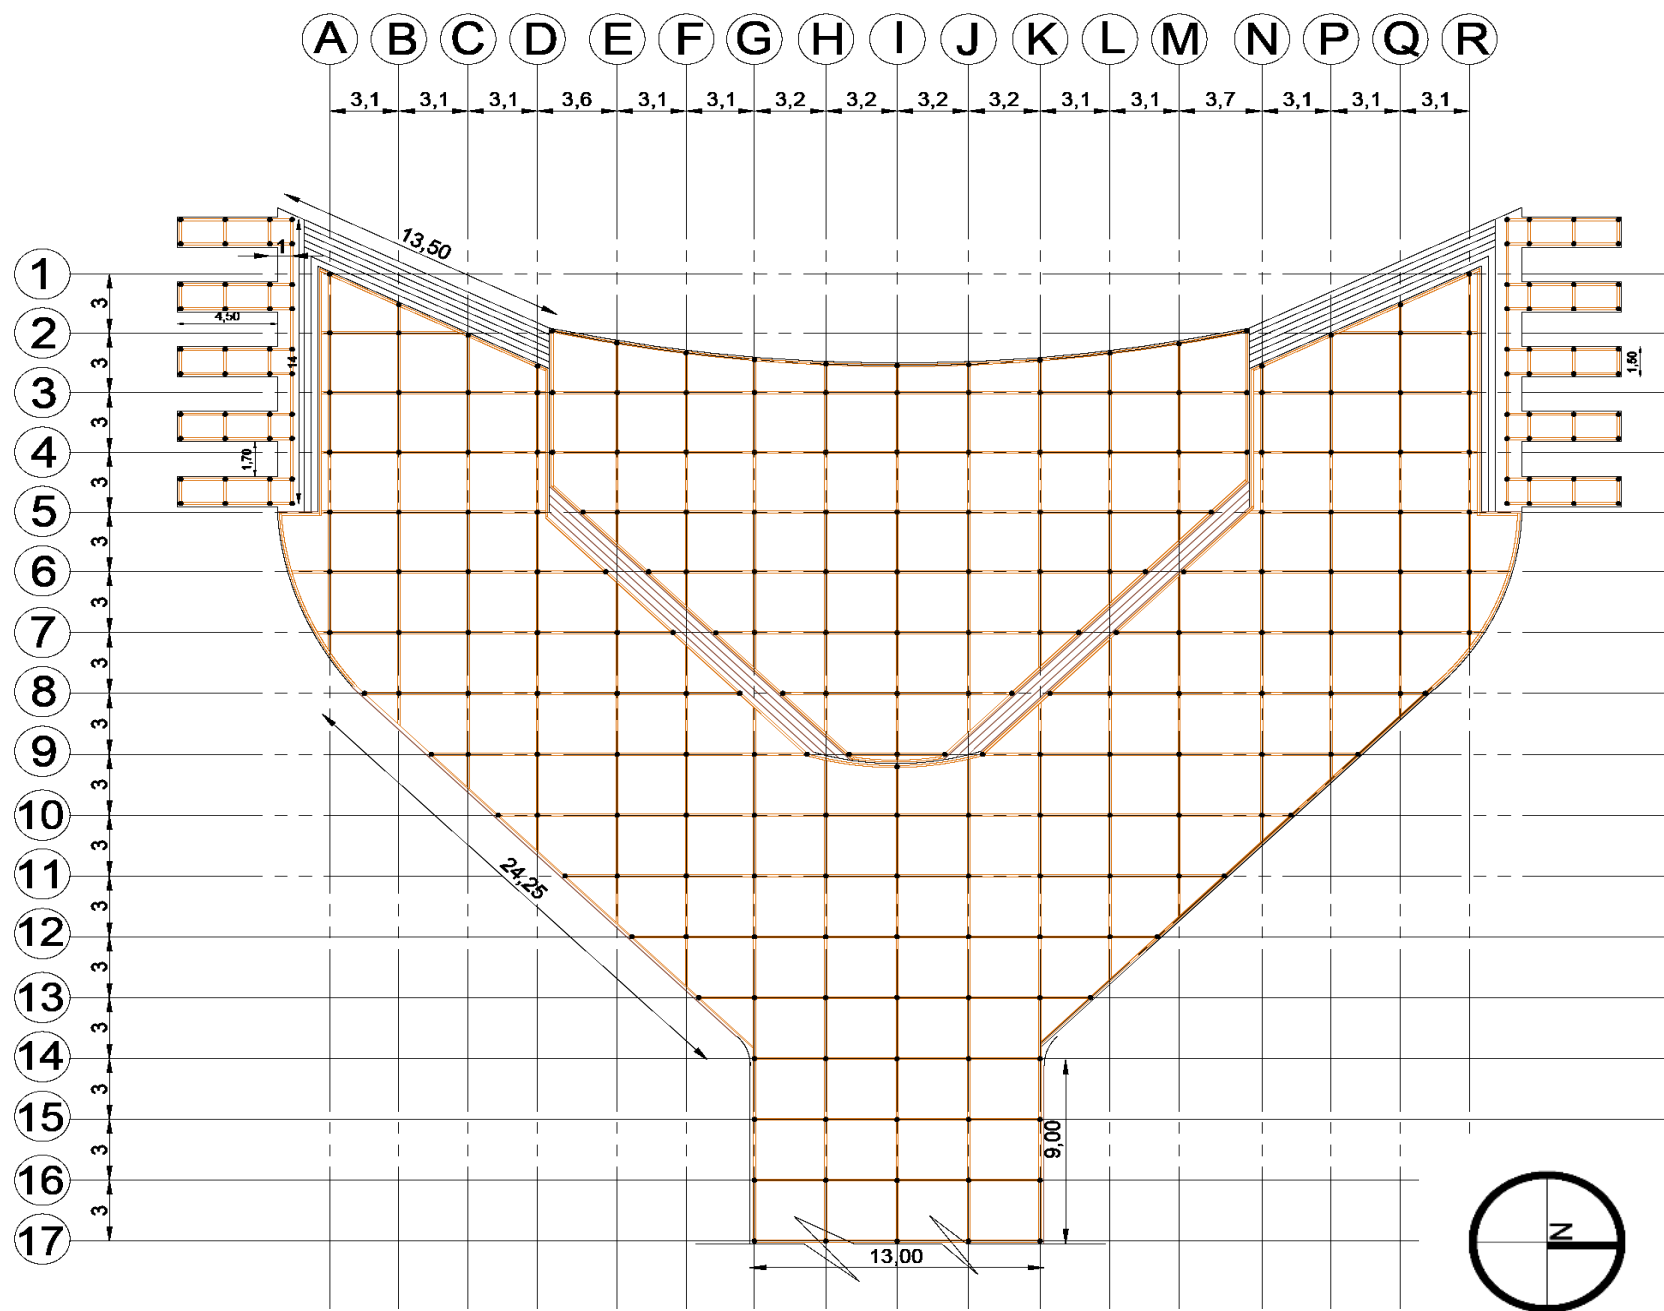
Planta estructural Plataforma 1. Fuente: Elaboración propia
